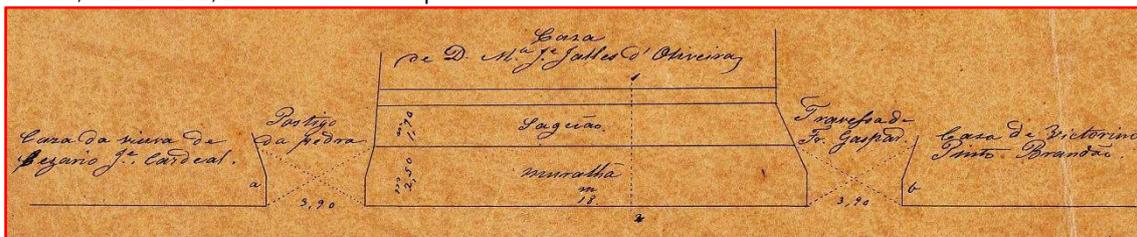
Desenho de “Planta” de um troço de muralha, com os Postigos da Pedra e da Travessa de Frei Gaspar. Pormenor da Figura 5.
